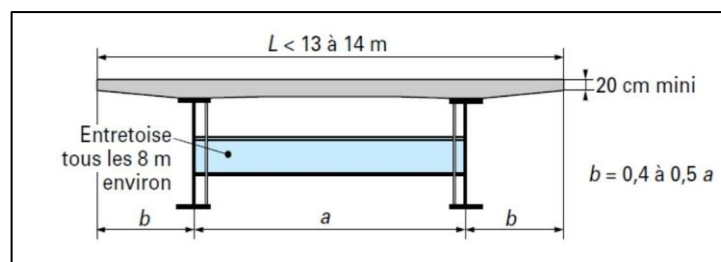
Schéma transversal d'un pont bipoutre à entretoise.
